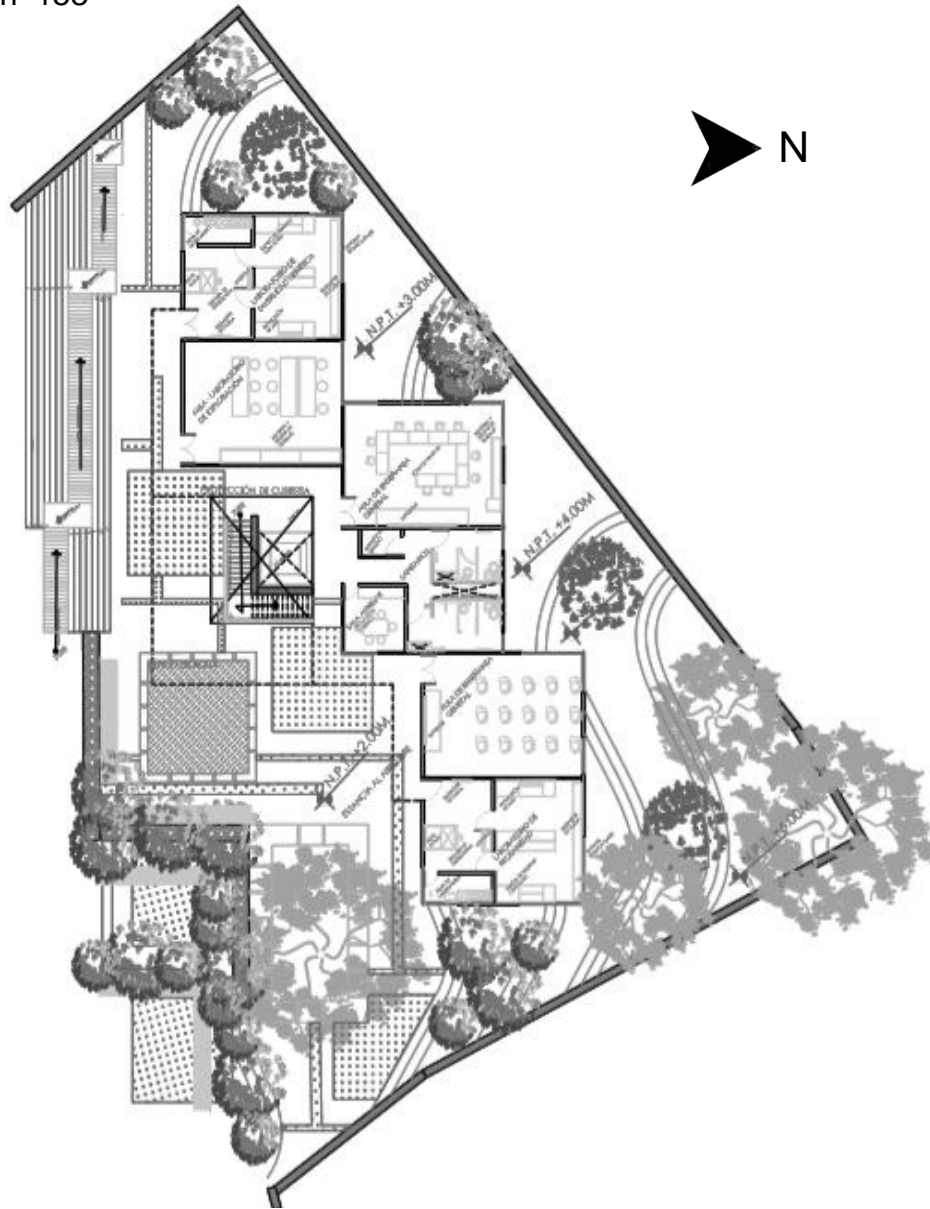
Planta arquitectónica de Escuela, Centro multidisciplinario Ex hacienda Cusi.
